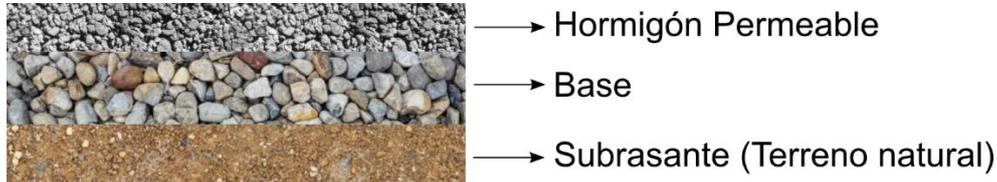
Sección transversal típica de sistema de hormigón permeable.
